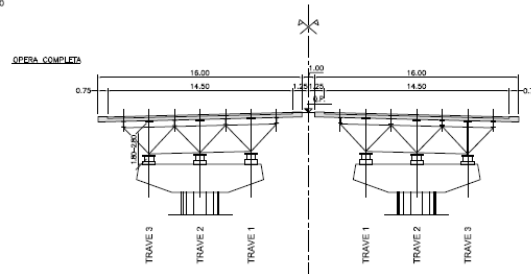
stralcio planimetrico e sezione del viadotto di progetto
